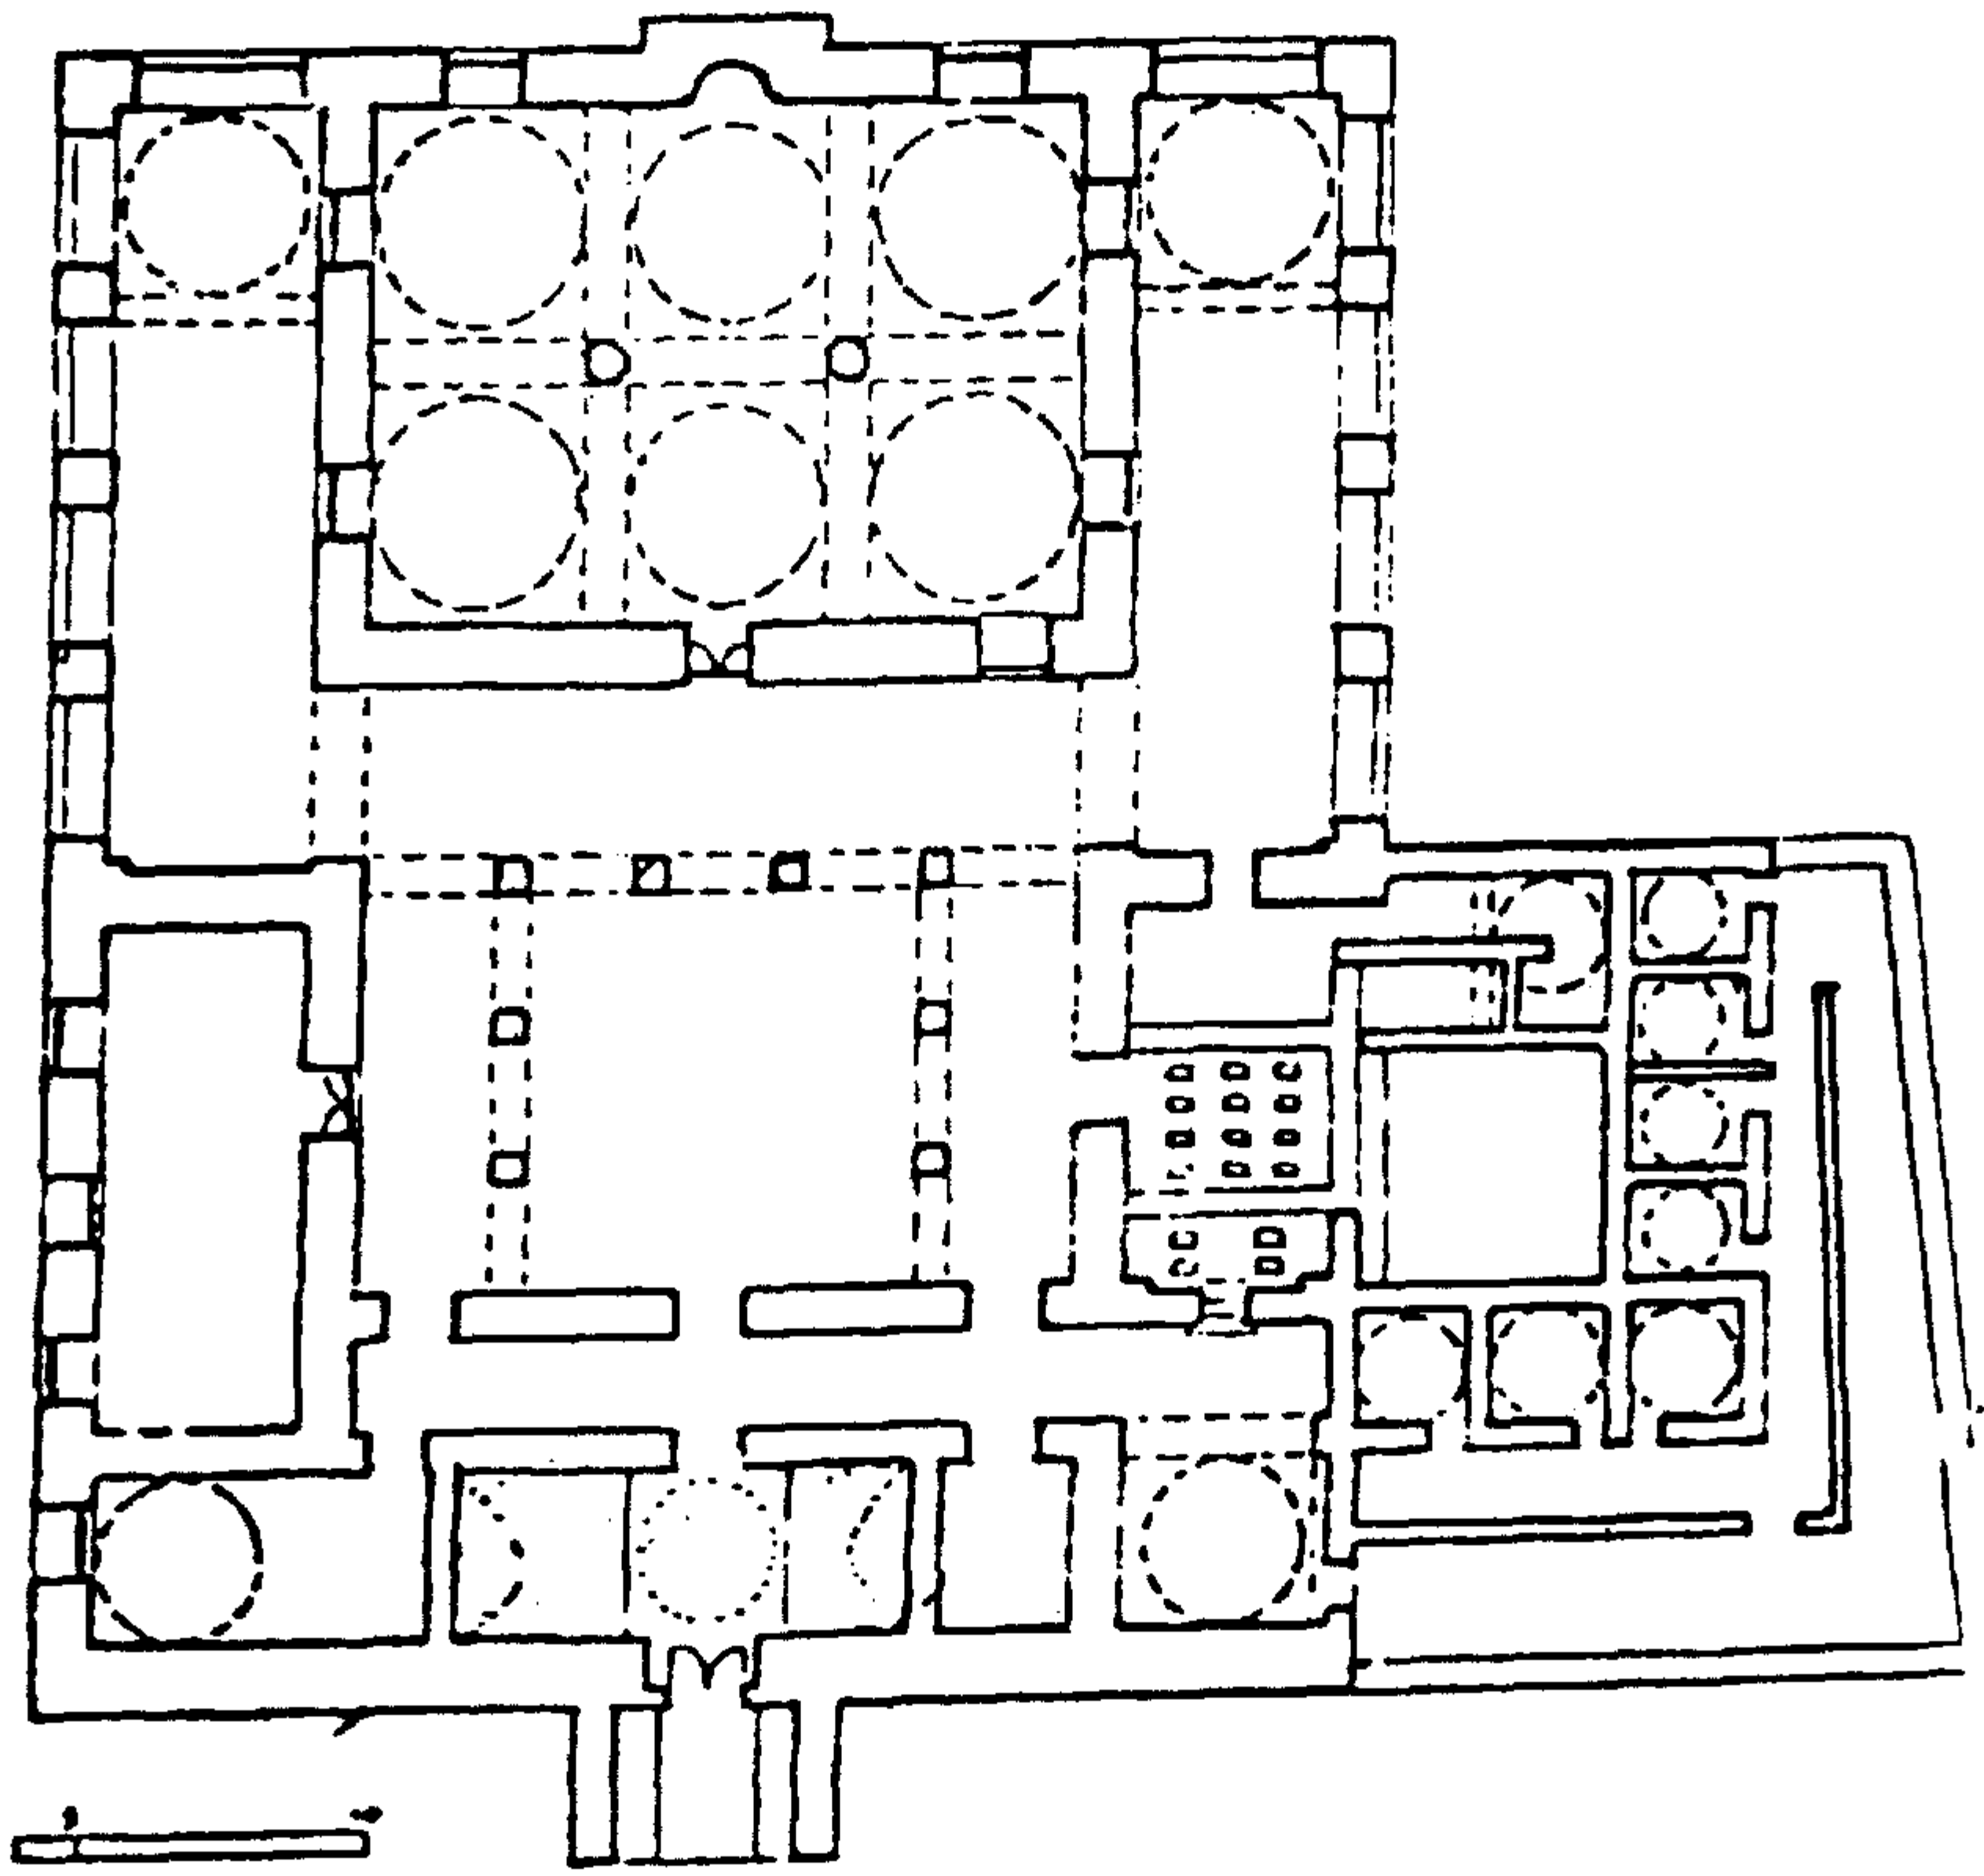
مسقط أفقي لمدرسة فيروز الساتقي بالقاهرة.
